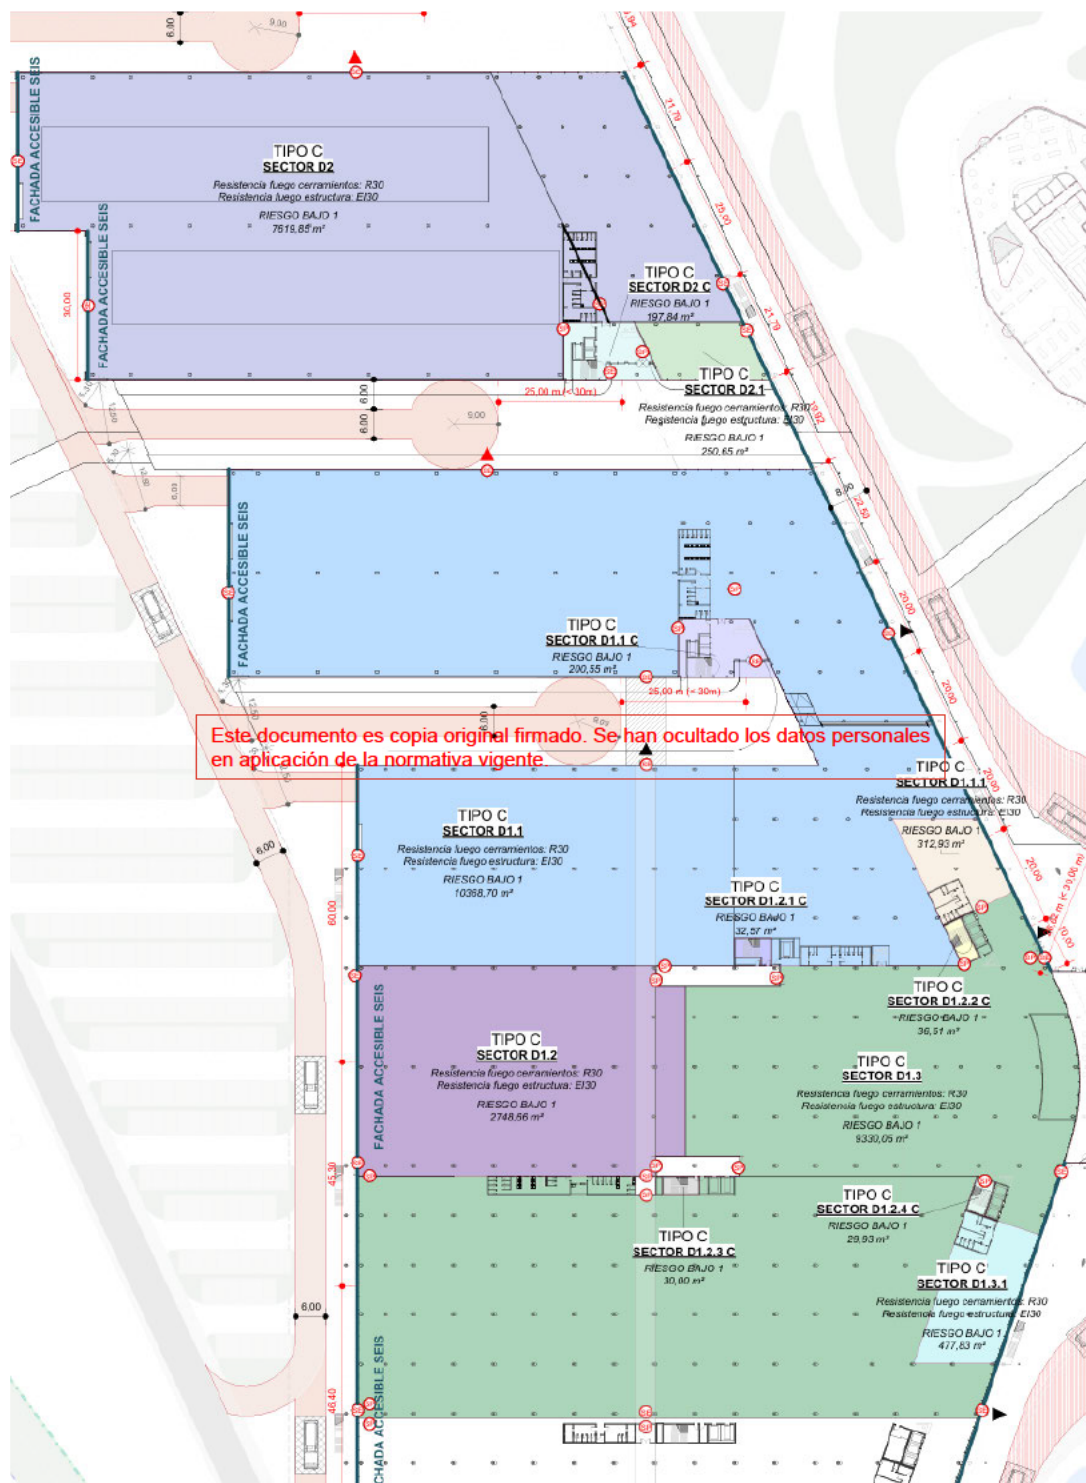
sectorización de los edificios D1 y D2 en planta baja
